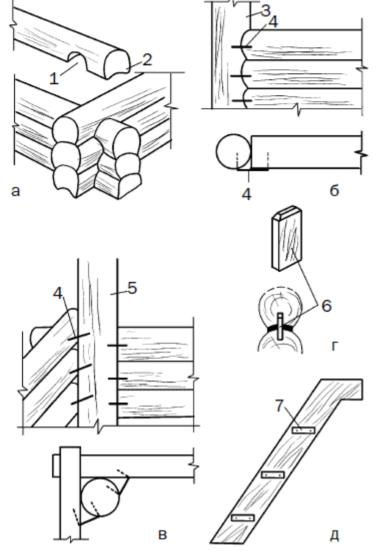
Последовательность постройки беседки: а - сборка сруба; б - крепление отрезков бревен скобами; в - прикрепление стен к внутренней стойке; г - соединение венцов шкантами; д - тетива лестницы; 1 - «чашка»; 2 - паз; 3 - стойка дверного проема; 4 - скоба; 5 - угловая стойка; 6 - шкант; 7 - опорный брусок
